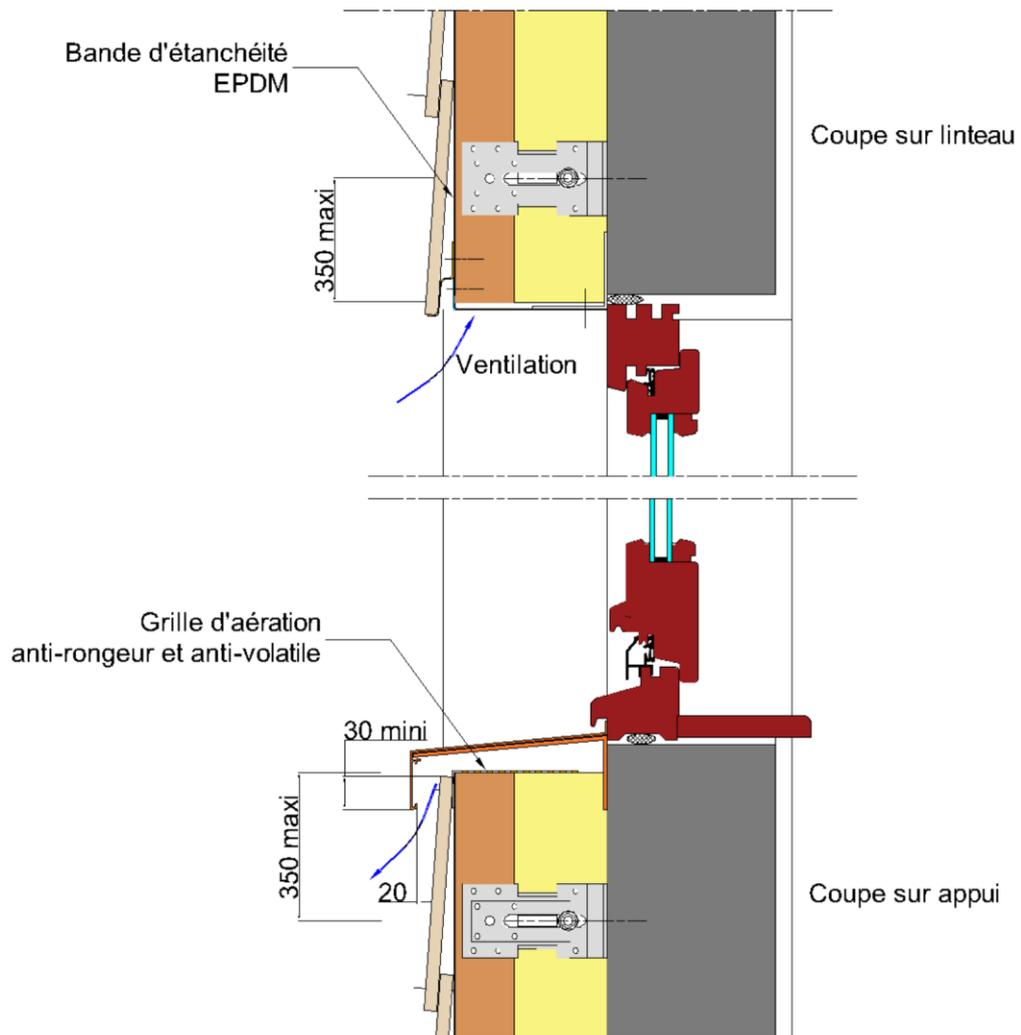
Encadrement de fenêtre – pose horizontale des lames CEDRAL LAP
